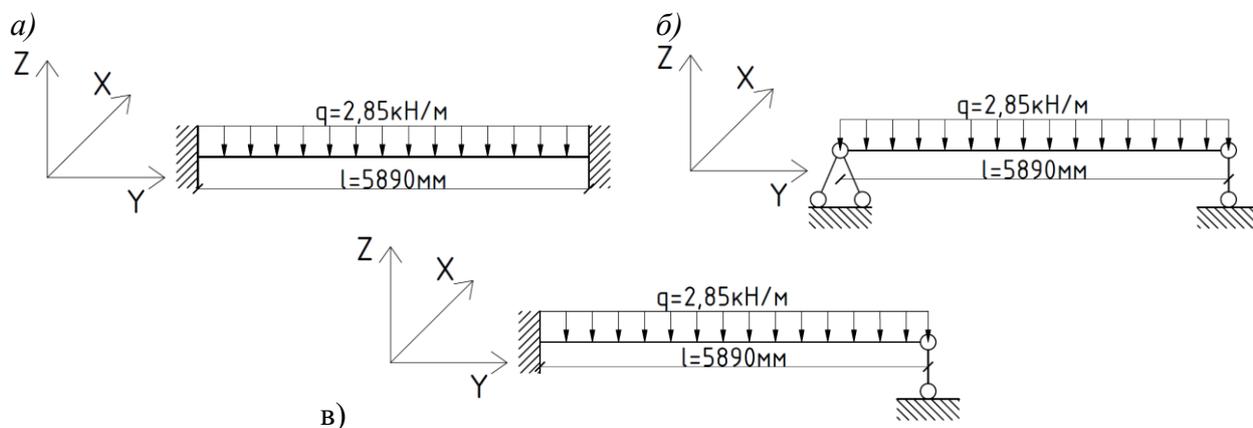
Расчетные схемы трехслойной плиты из ДПК с граничными условиями: а) жесткое защемление; б) шарнирное опирание; в) жесткое защемление с шарниром
